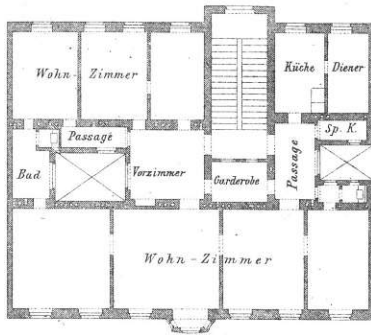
Grundriss 1., 2. und 3. Obergeschoss, Garnisonsgasse 10, Oskar Merz, 1891
